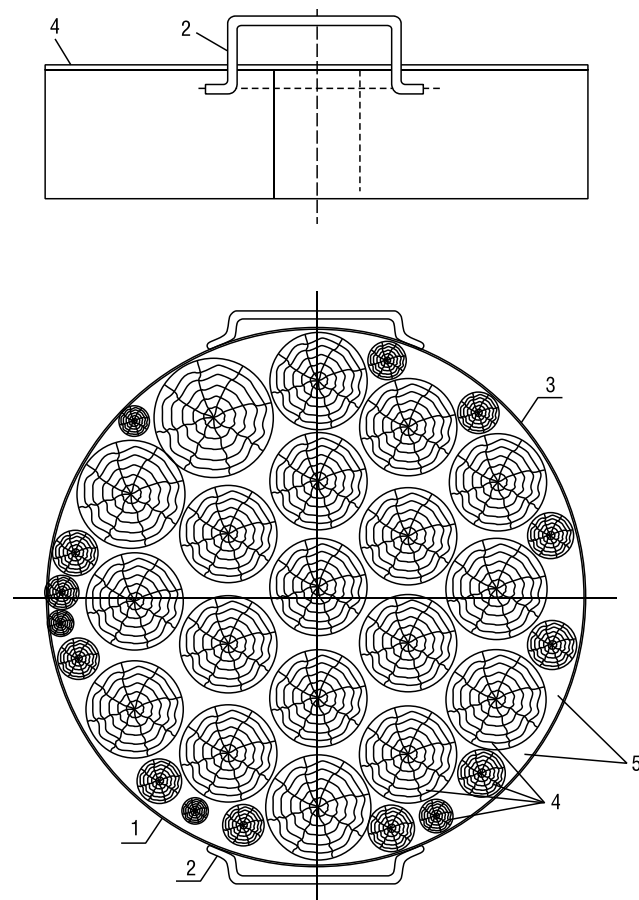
Блок деревянно-бетонный: 1 - стальная обойма; 2 - ручка; 3 - стяжки; 4 - деревянные стойки; 5 - мелкозернистый бетон
